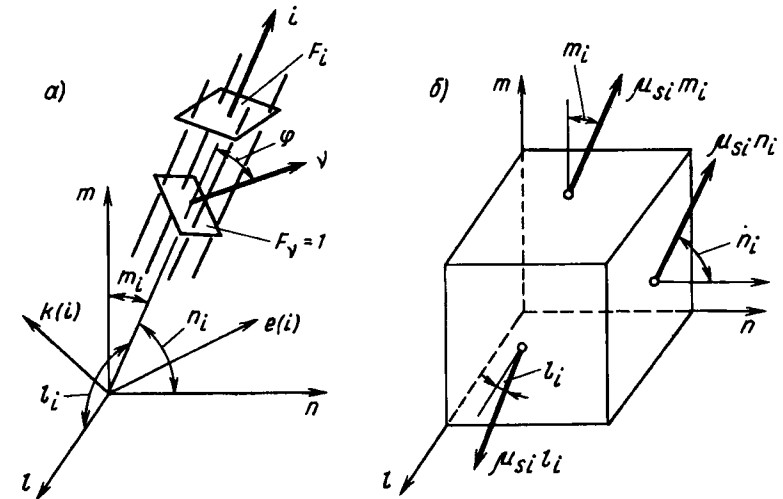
К определению площади арматуры, пересекающей наклонные площадки
